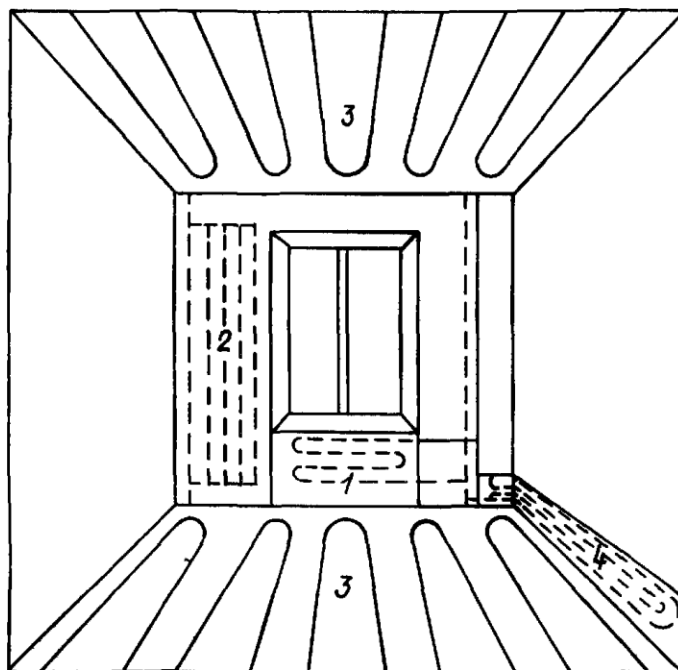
Типи бетонних опалювальних панелей: 1 - підвіконна; 2-стінна; 3 - стельово-підлогова; 4-плінтусна
